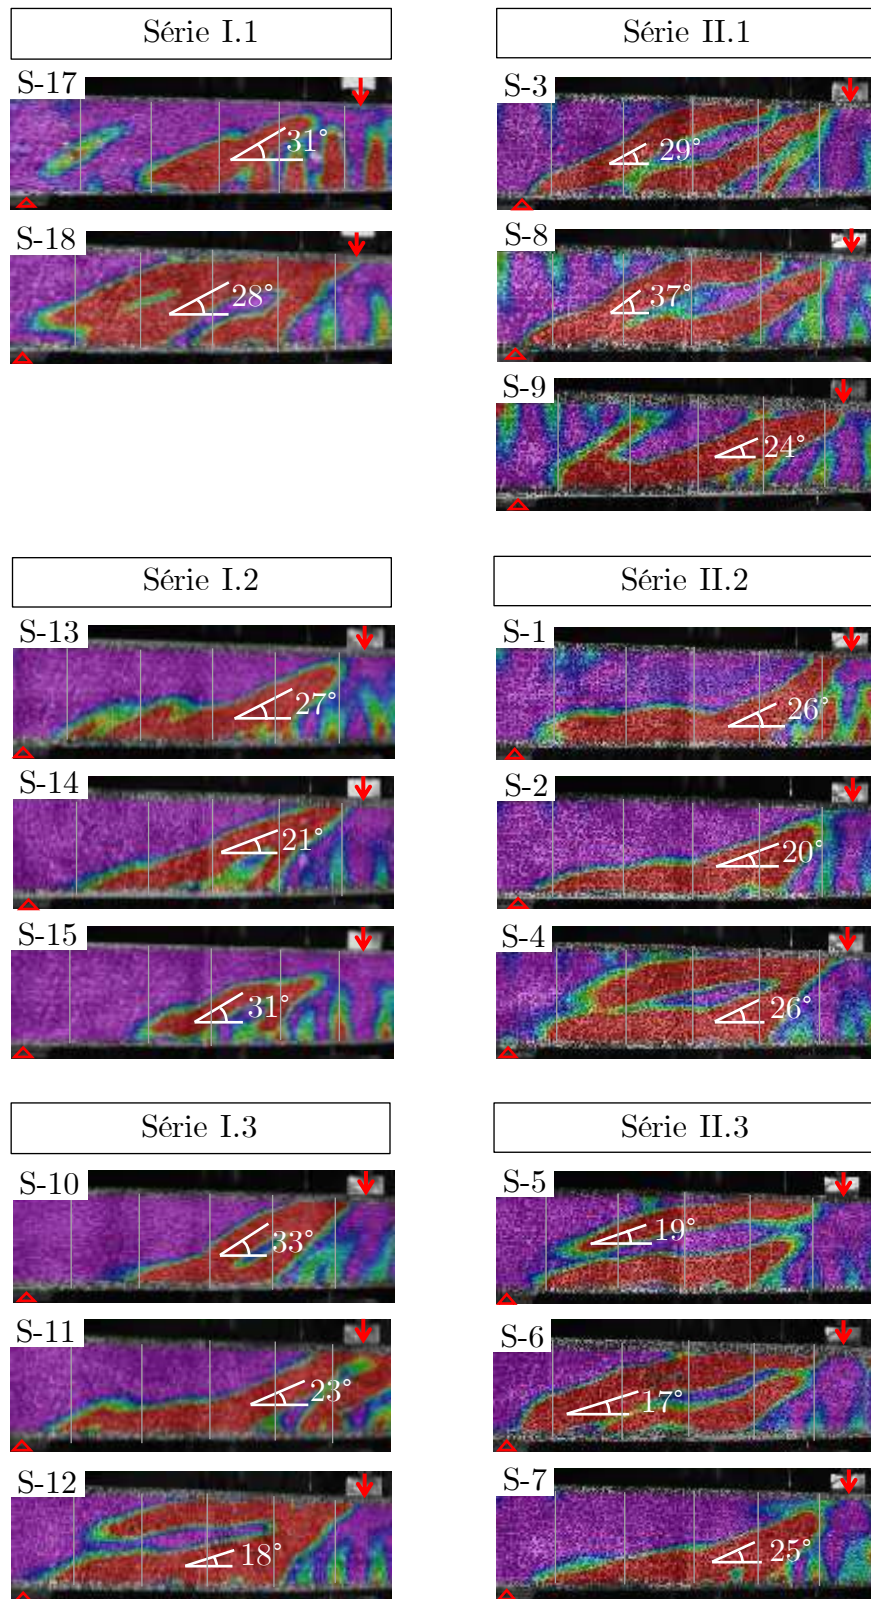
Fissures des poutres avec cadres
